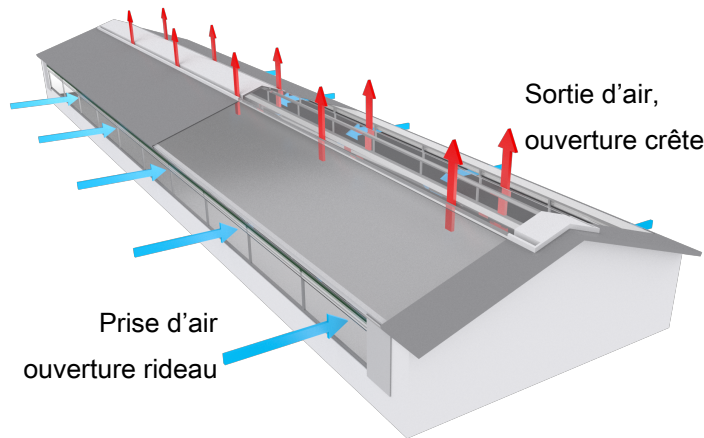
Par exemple, dans un bâtiment à la ventilation naturelle pure avec des ouvertures rideaux sur les côtés du bâtiment et une ouverture crête sur le toit.
